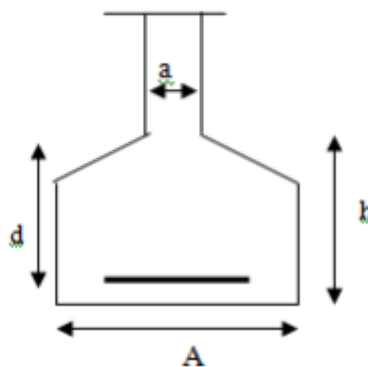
Dimensionnement d'une semelle isolée dans le sens x-x.
